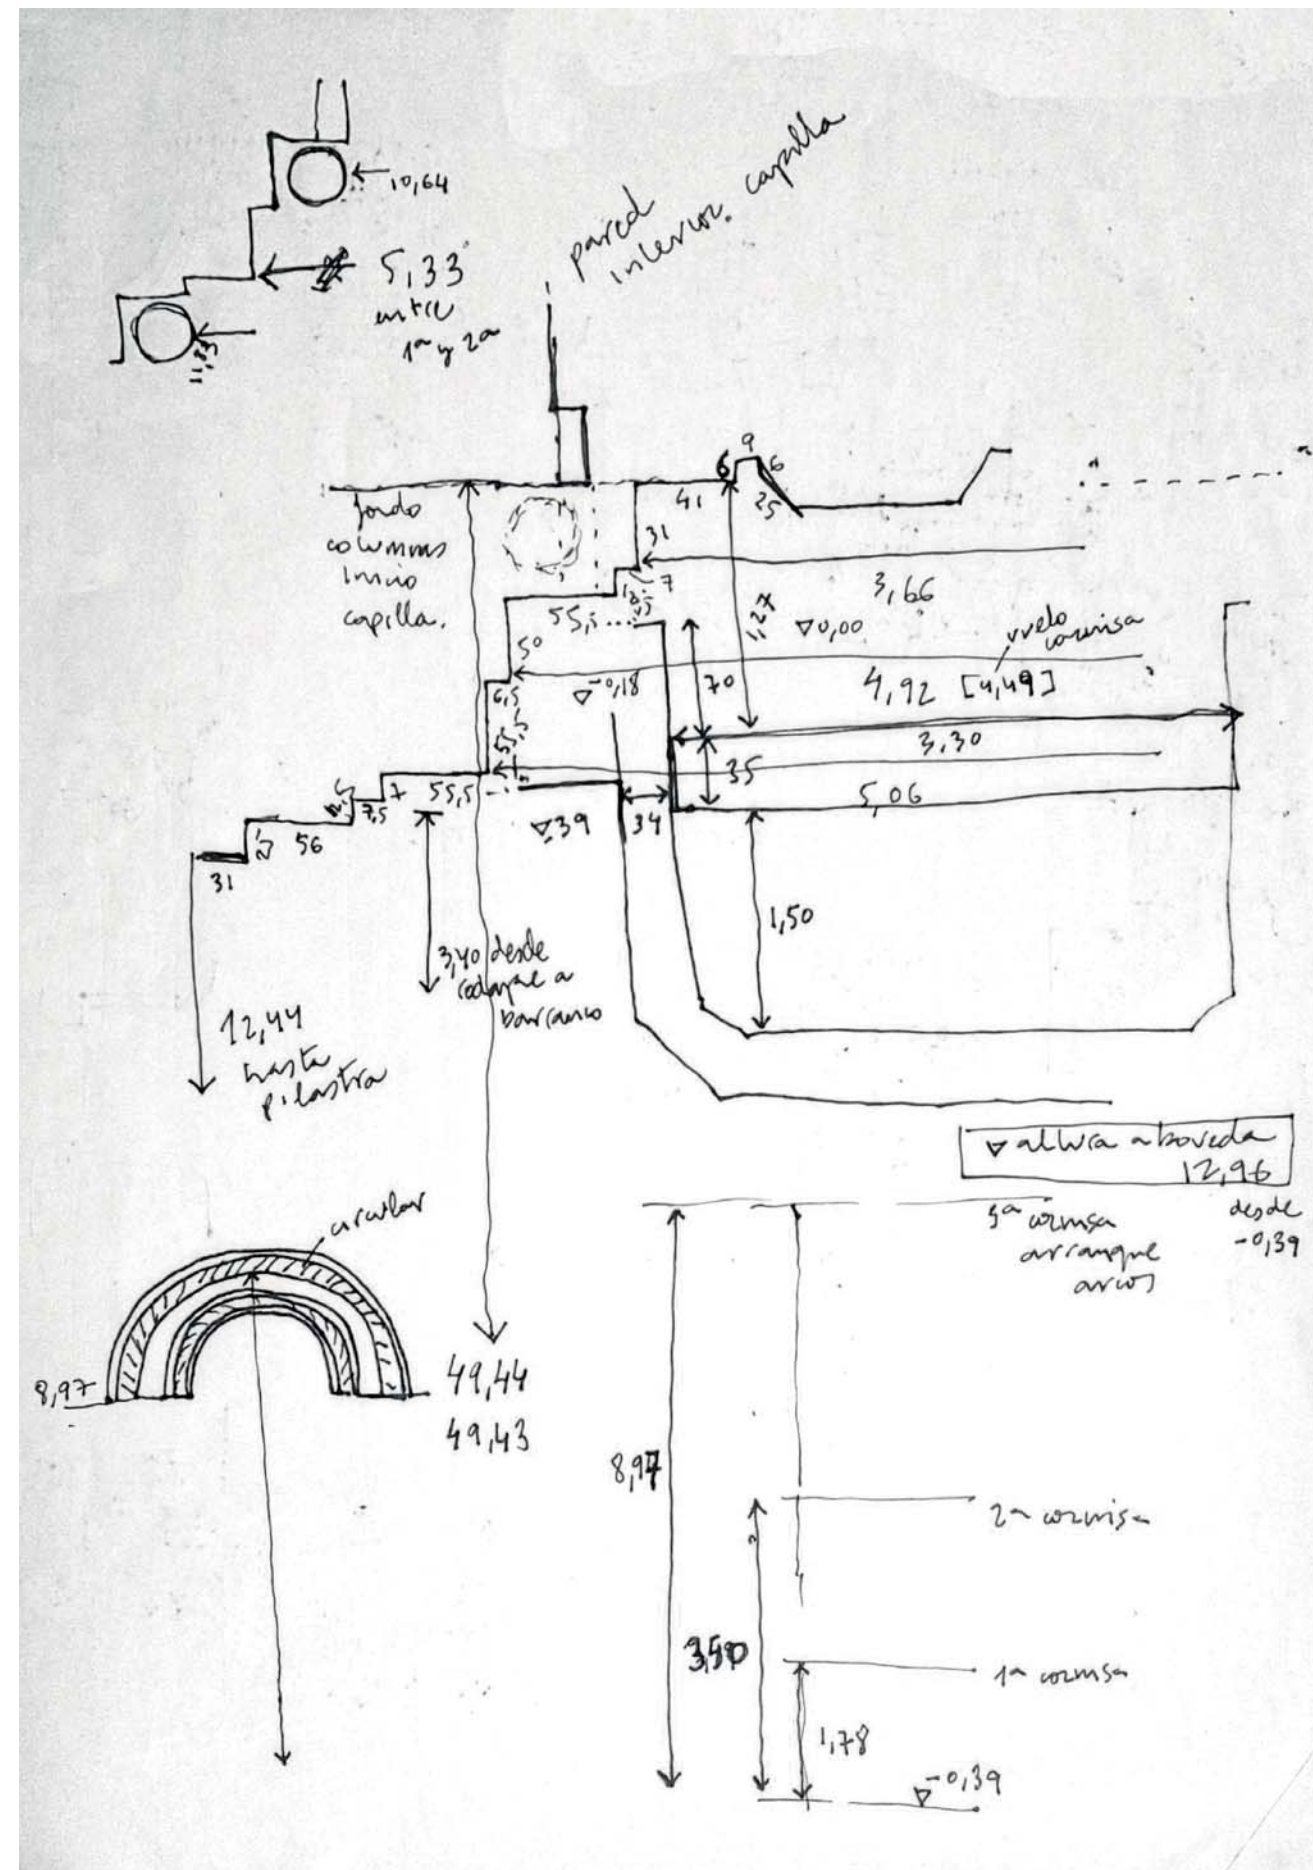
Croquis del detalle en planta del retablo y de las capillas de la Iglesia de San Domingos de Viana do Castelo y detalles de la cornisa de la nave y de las pilastras y puertas
